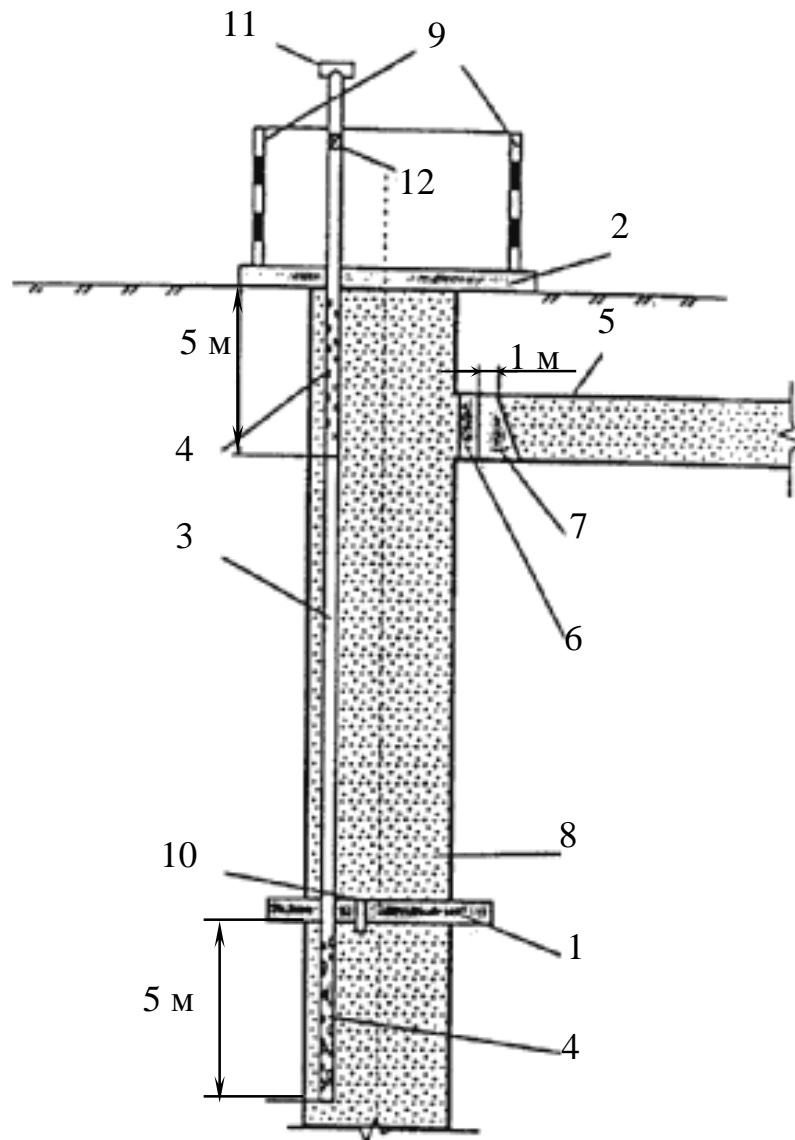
Фрагмент верхней части ликвидированного ствола: 1 – полок перекрытия ствола; 2 – полок перекрытия устья ствола; 3 – газоотводящий трубопровод; 4 – перфорированная часть газоотводящего трубопровода; 5 – вентиляционный канал; 6 – глухая перемычка; 7 – глиняный «замок»; 8 – закладочный материал; 9 – ограждение газоотводящего трубопровода; 10 – труба для перепуска воды; 11 – дефлектор; 12 – огнепреградитель
